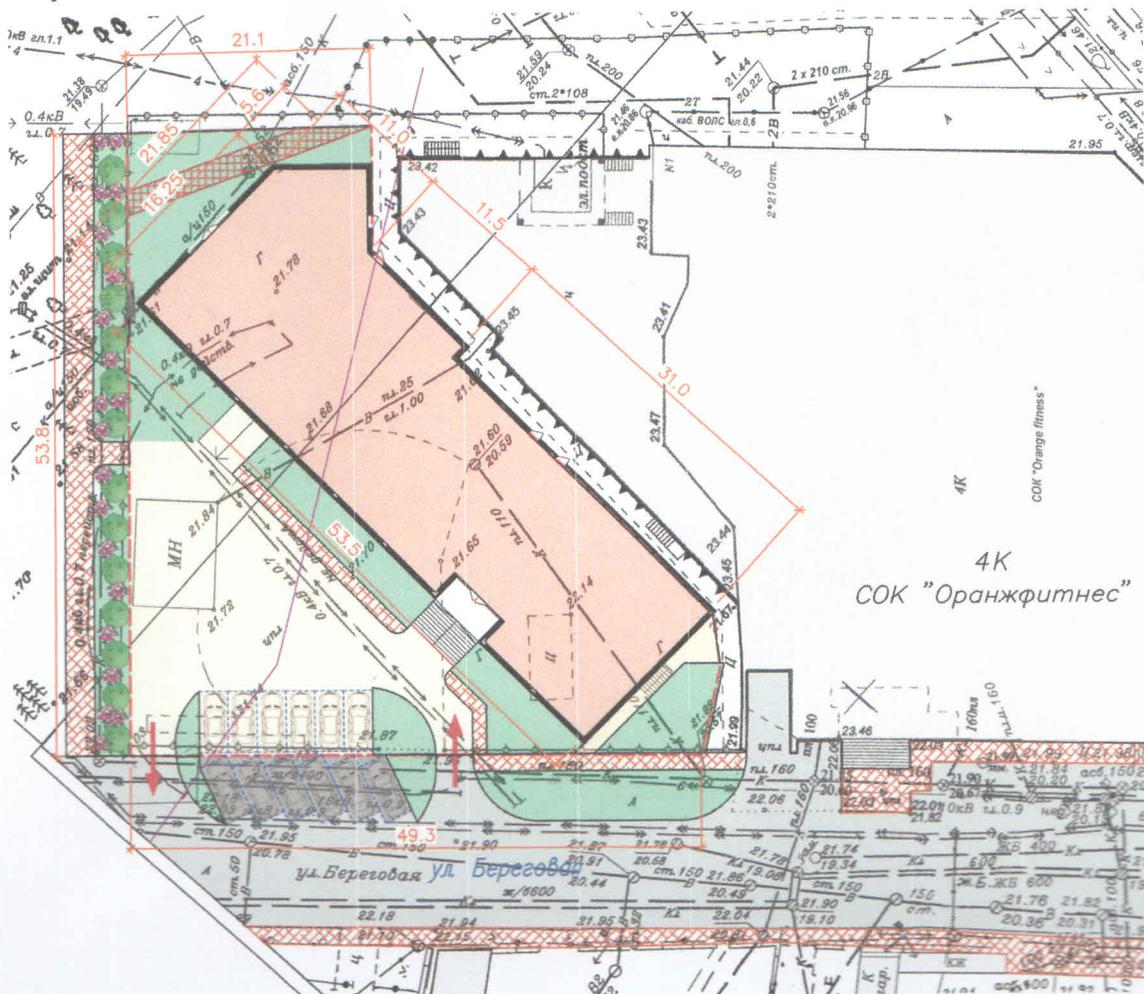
Схема планируемой застройки земельного участка (вид в плане)
